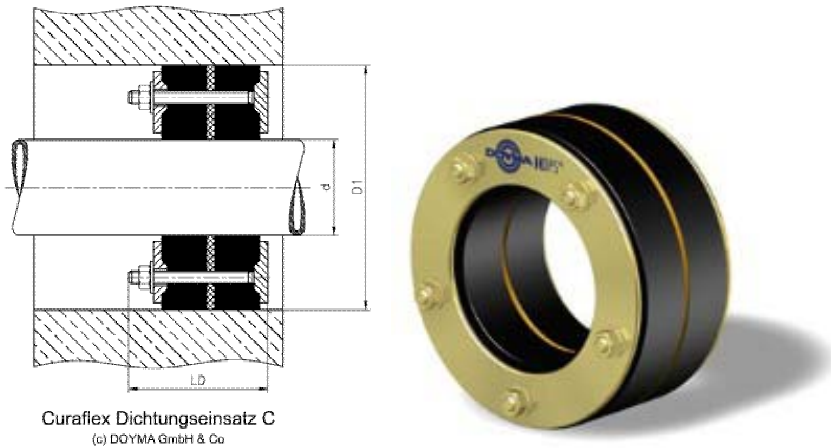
Beispiel Dichtungseinsatz gegen drückendes Wasser in Weißer Wanne
